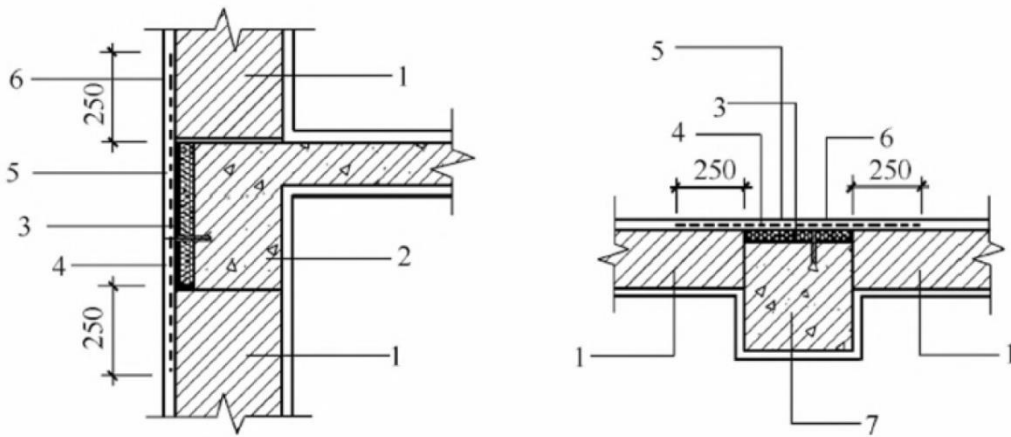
梁、柱与墙体交接处保温处理的构造做法示意图
